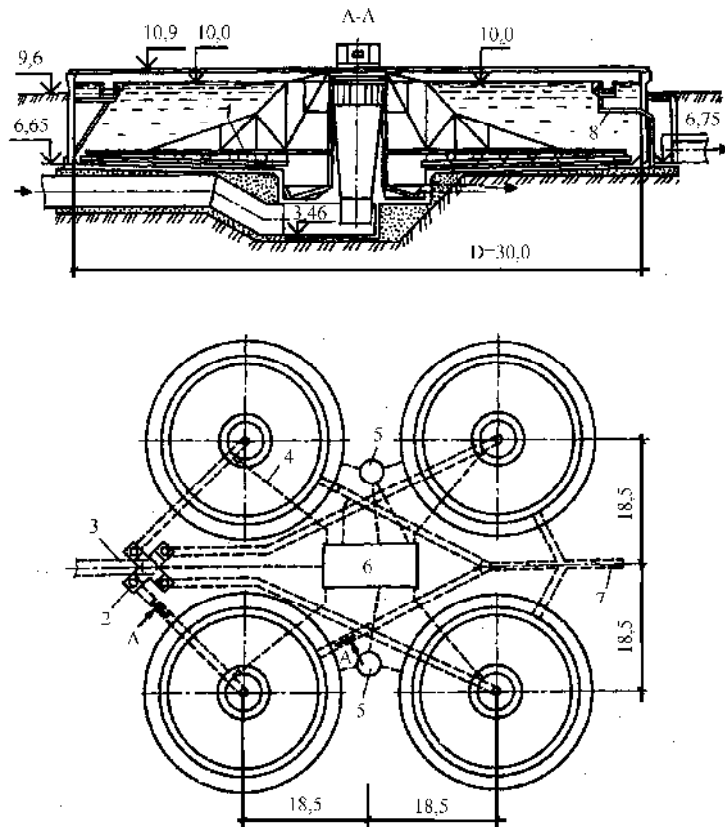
Первичные радиальные отстойники: 1 – илоскреб; 2 – распределительная камера; 3 – подводящий трубопровод; 4 – трубопровод выгрузки осадка; 5 – жироборник; 6 – насосная станция перекачки осадка; 7 – трубопровод отвода осветленной воды; 8 – жиропровод
